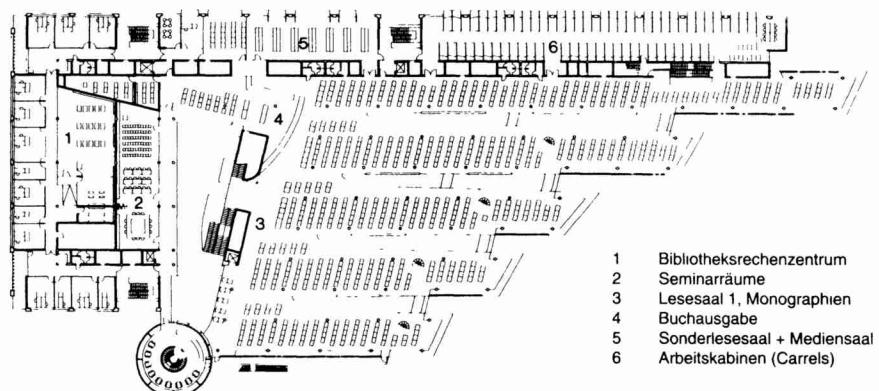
SUB-Grundriß, 1. Obergeschoß
